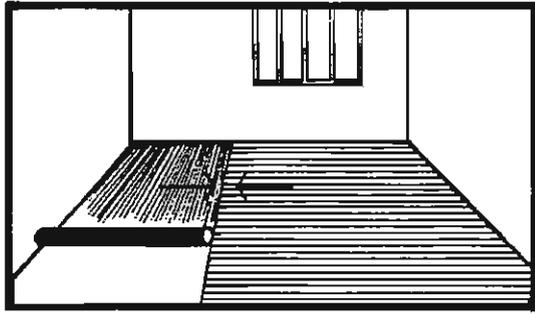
Enrolamento da manta e aplicação do adesivo sobre o substrato [Fonte: SOMMER].
